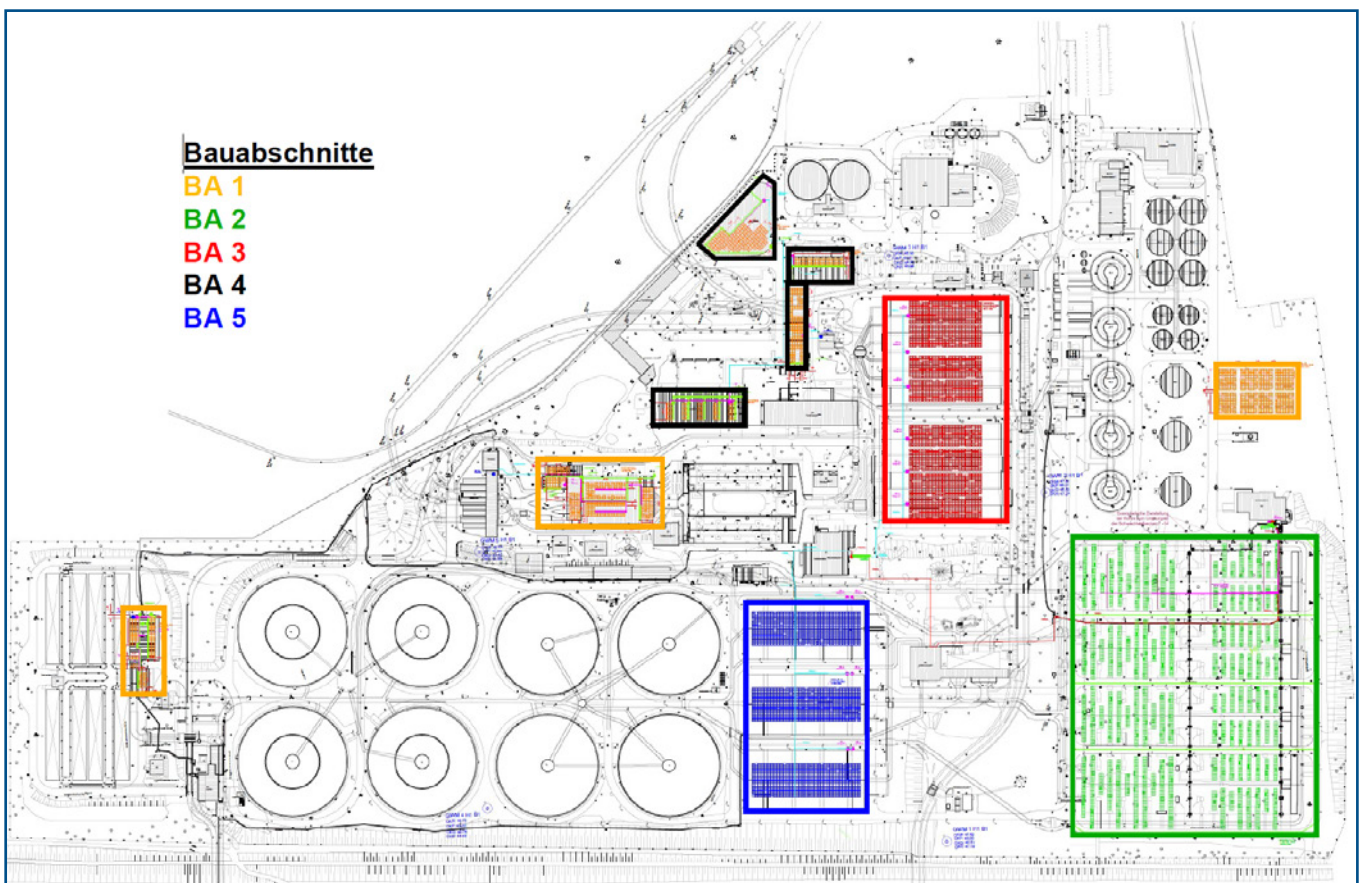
Lageplan mit Potenzialflächen GKW / © StEB Köln
